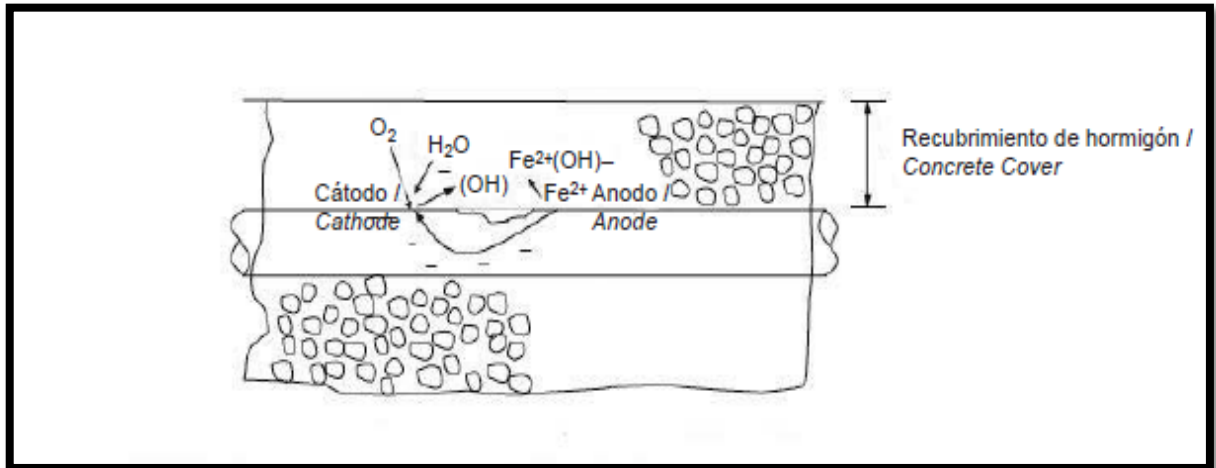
Proceso de corrosión del acero de refuerzo en hormigón.
